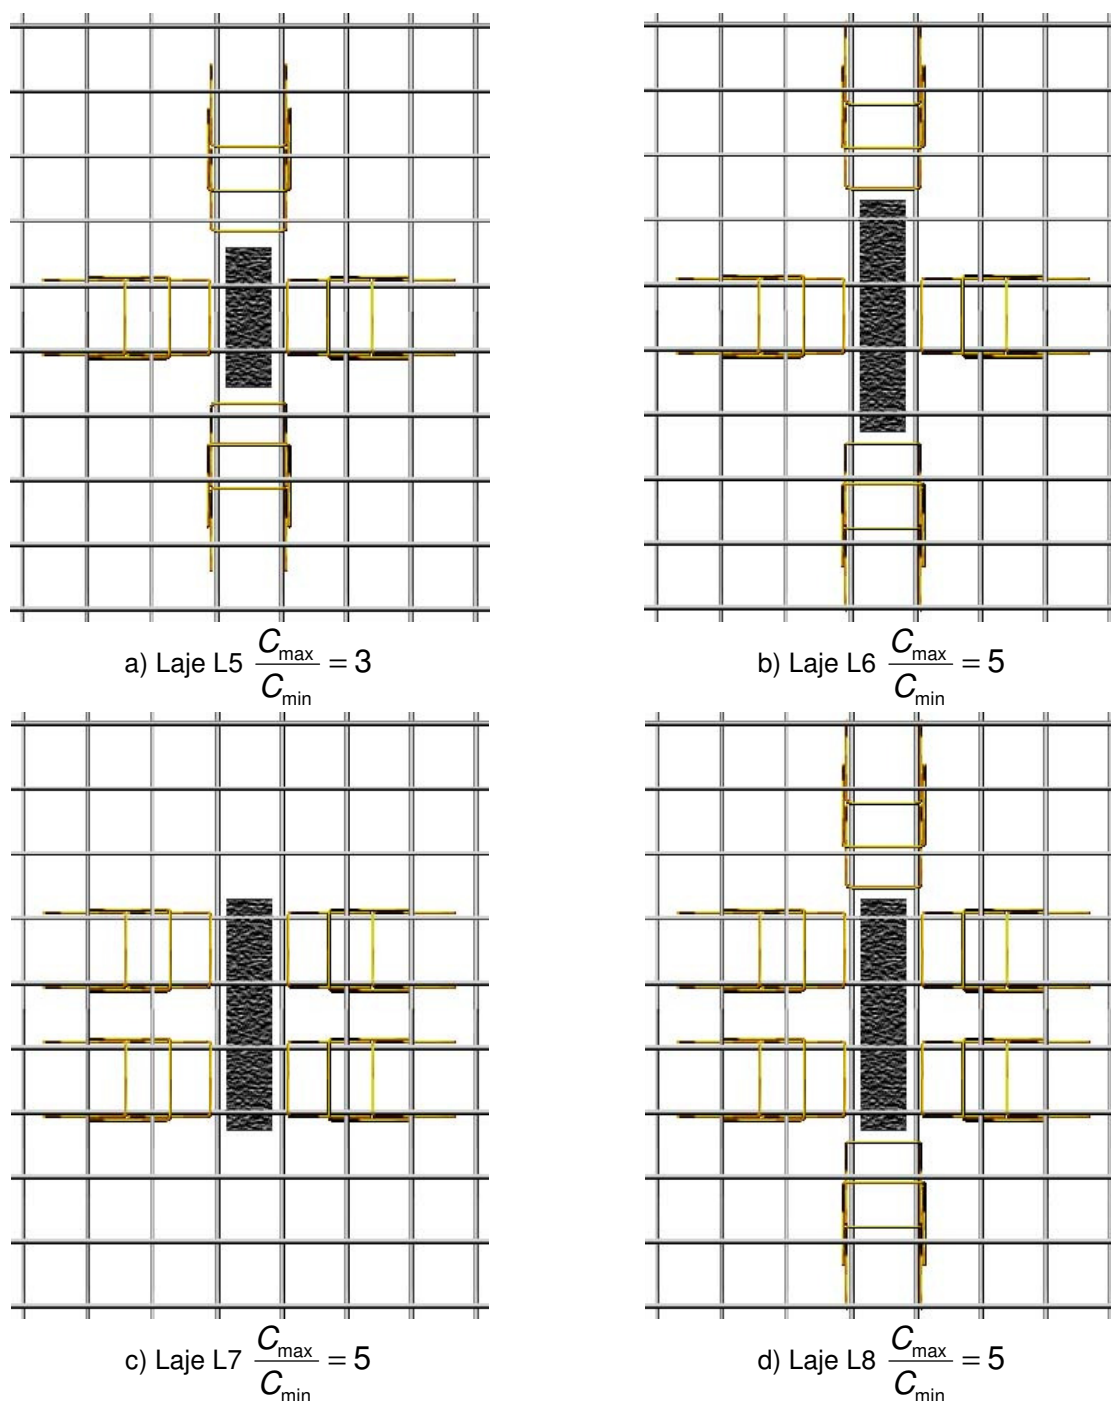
Detalhe esquemático das lajes L5 a L8
